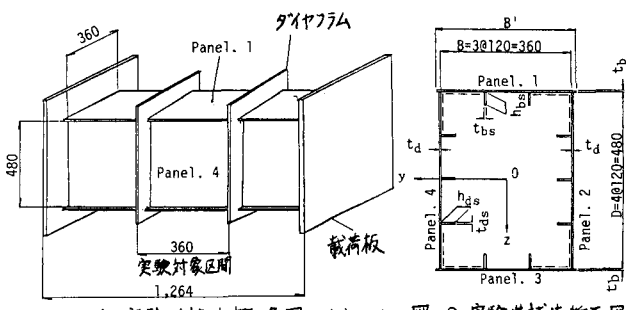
実験供試体概略図 (単位mm) 図-2 実験供試体断面図
